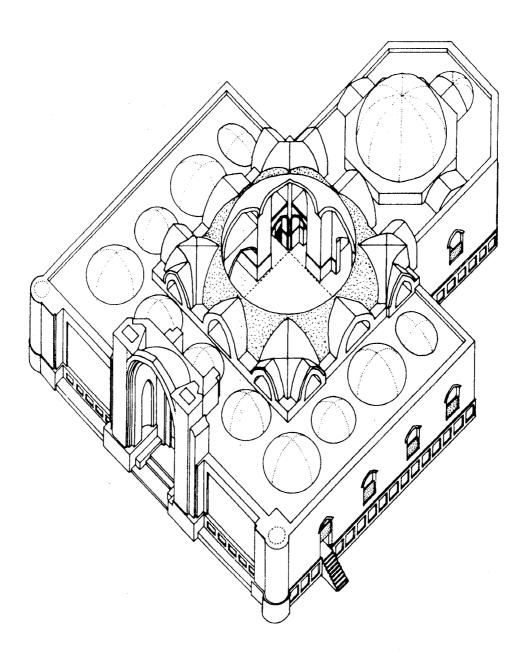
مسقط أفقي لعمارت ميخال أو غلو محمد بك في اهتمان ببلغاريا (عن : كيل) .
